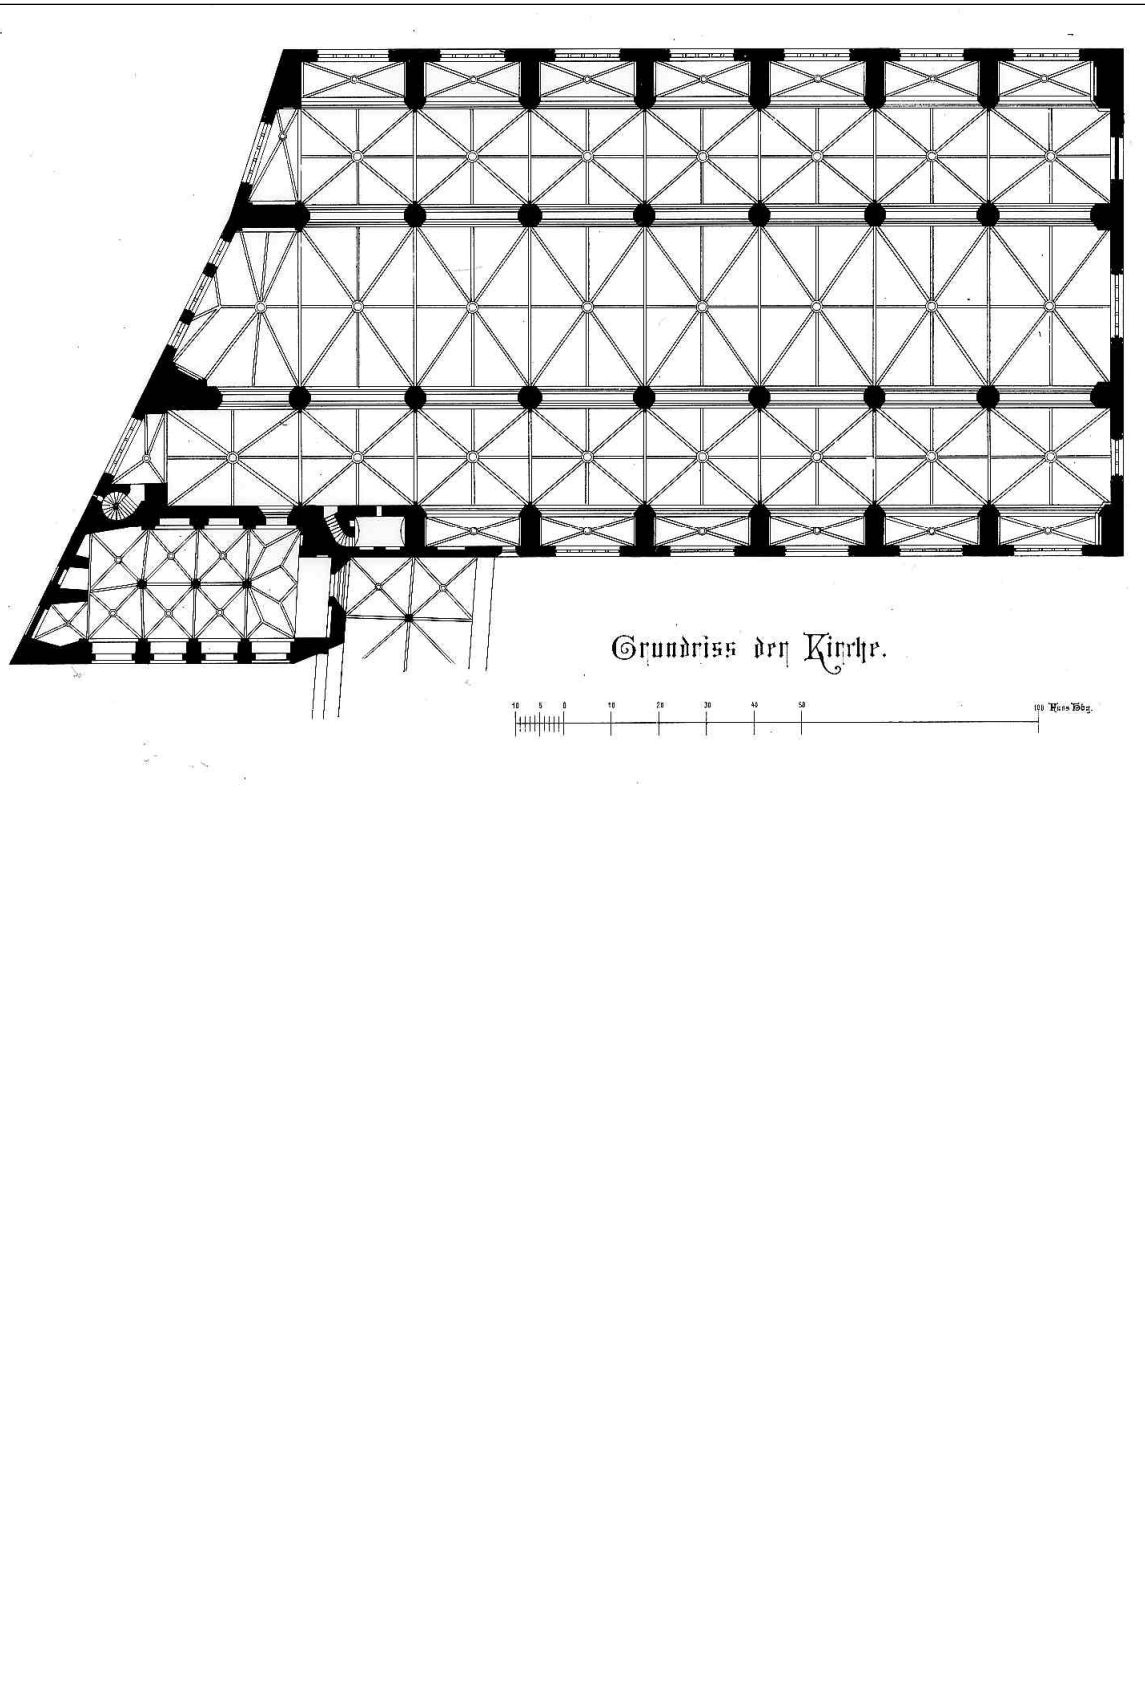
St. Johannis, Hamburg, Grundriss der Kirche
